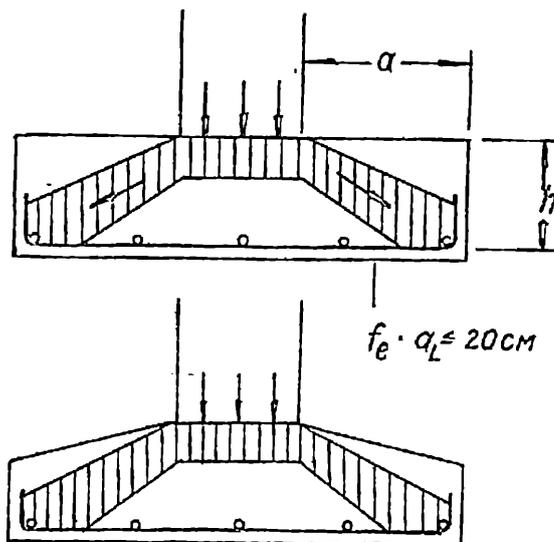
4. Воздействие нагрузки и арматура ленточных фундаментов
